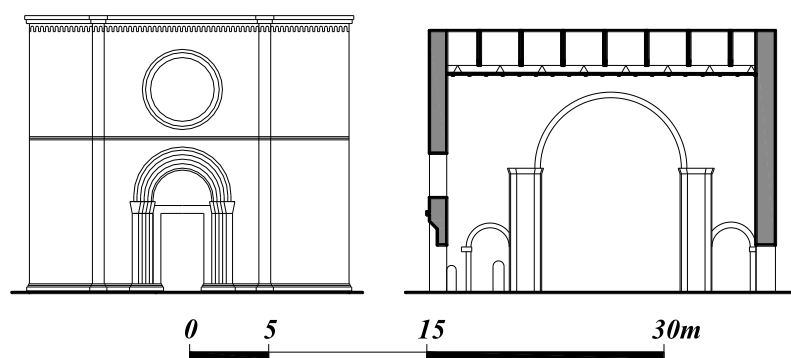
Chiesa di S. Giusta: Facciata e sezione trasversale in corrispondenza dell'arco trionfale
